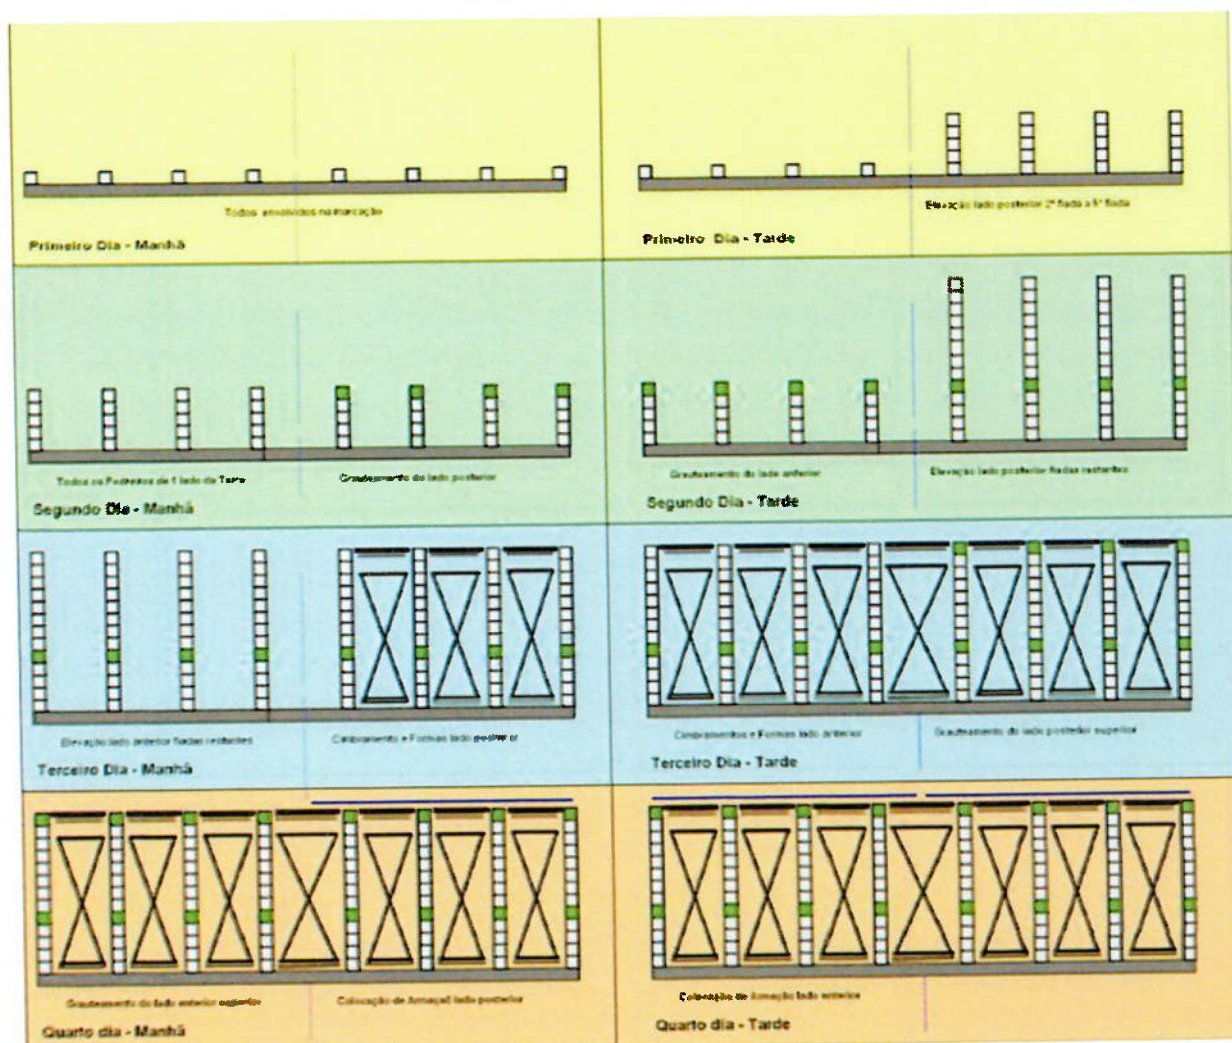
Ciclo para a execução da estrutura em alvenaria estrutural
